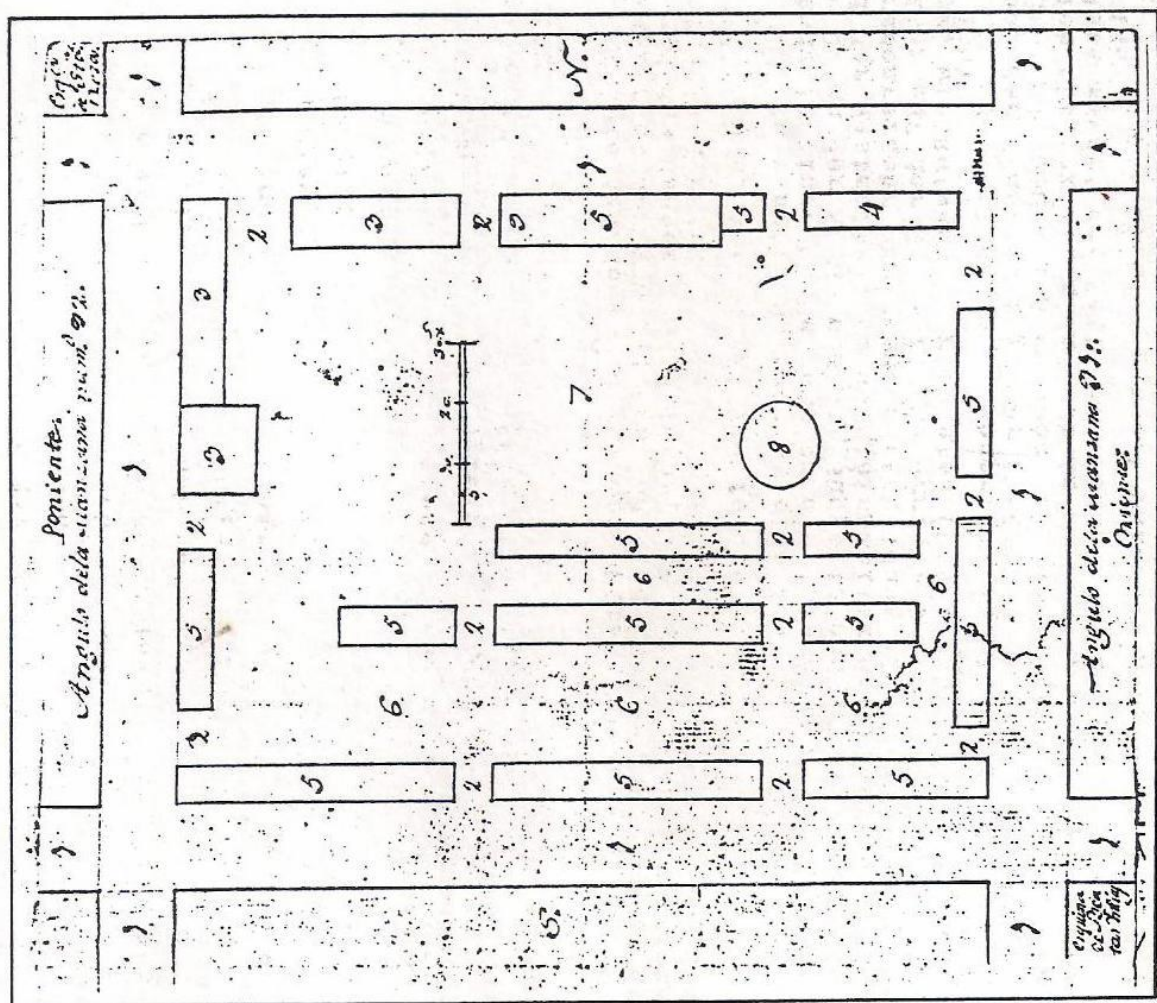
Plano de la plazuela de Santa Rosa en 1777.<sup>1781</sup>
